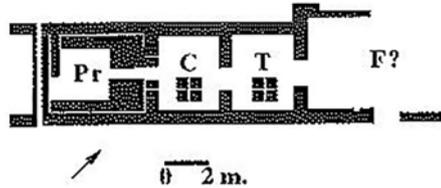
Planta de los baños de Camp de la Torre, Barcelona (GARCÍA, 2003).
